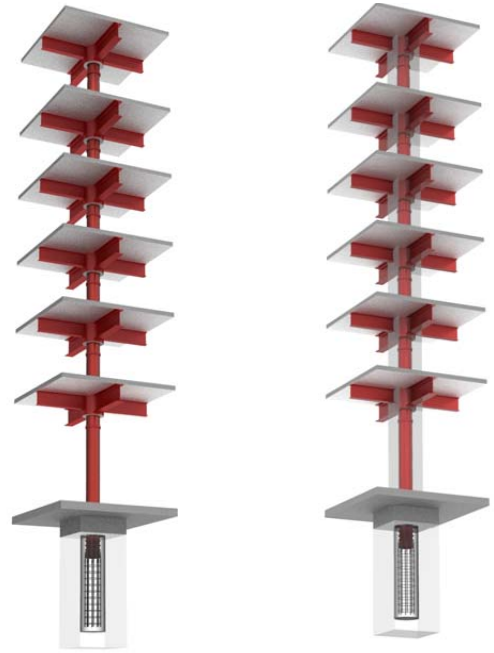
ES-TD Grout-Jacket Connection System의 공사순서
